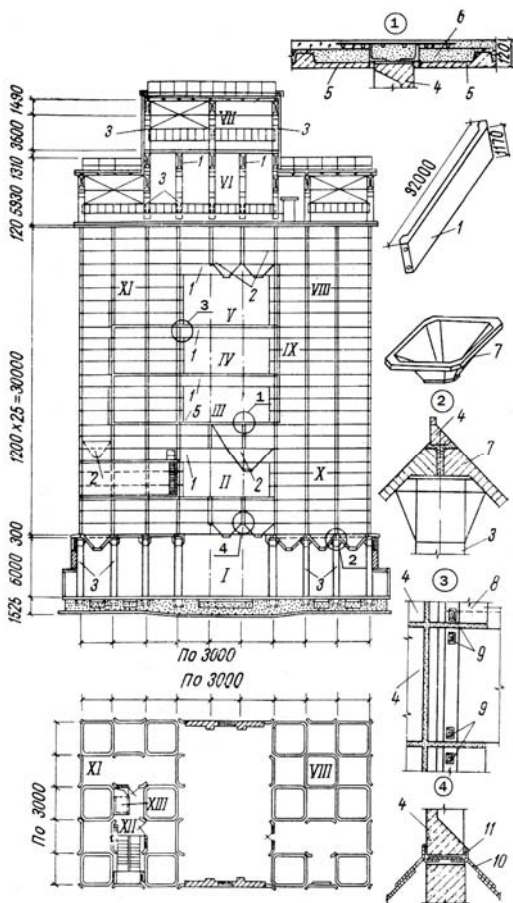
Повздовжній розріз і план робочої будівлі елеватора з збірною залізобетоноу:
